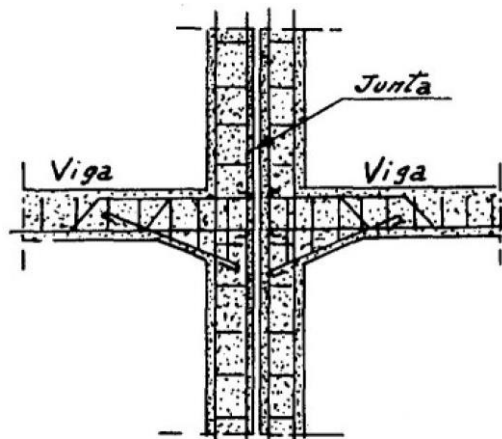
Detalle de junta de dilatación de doble columna
